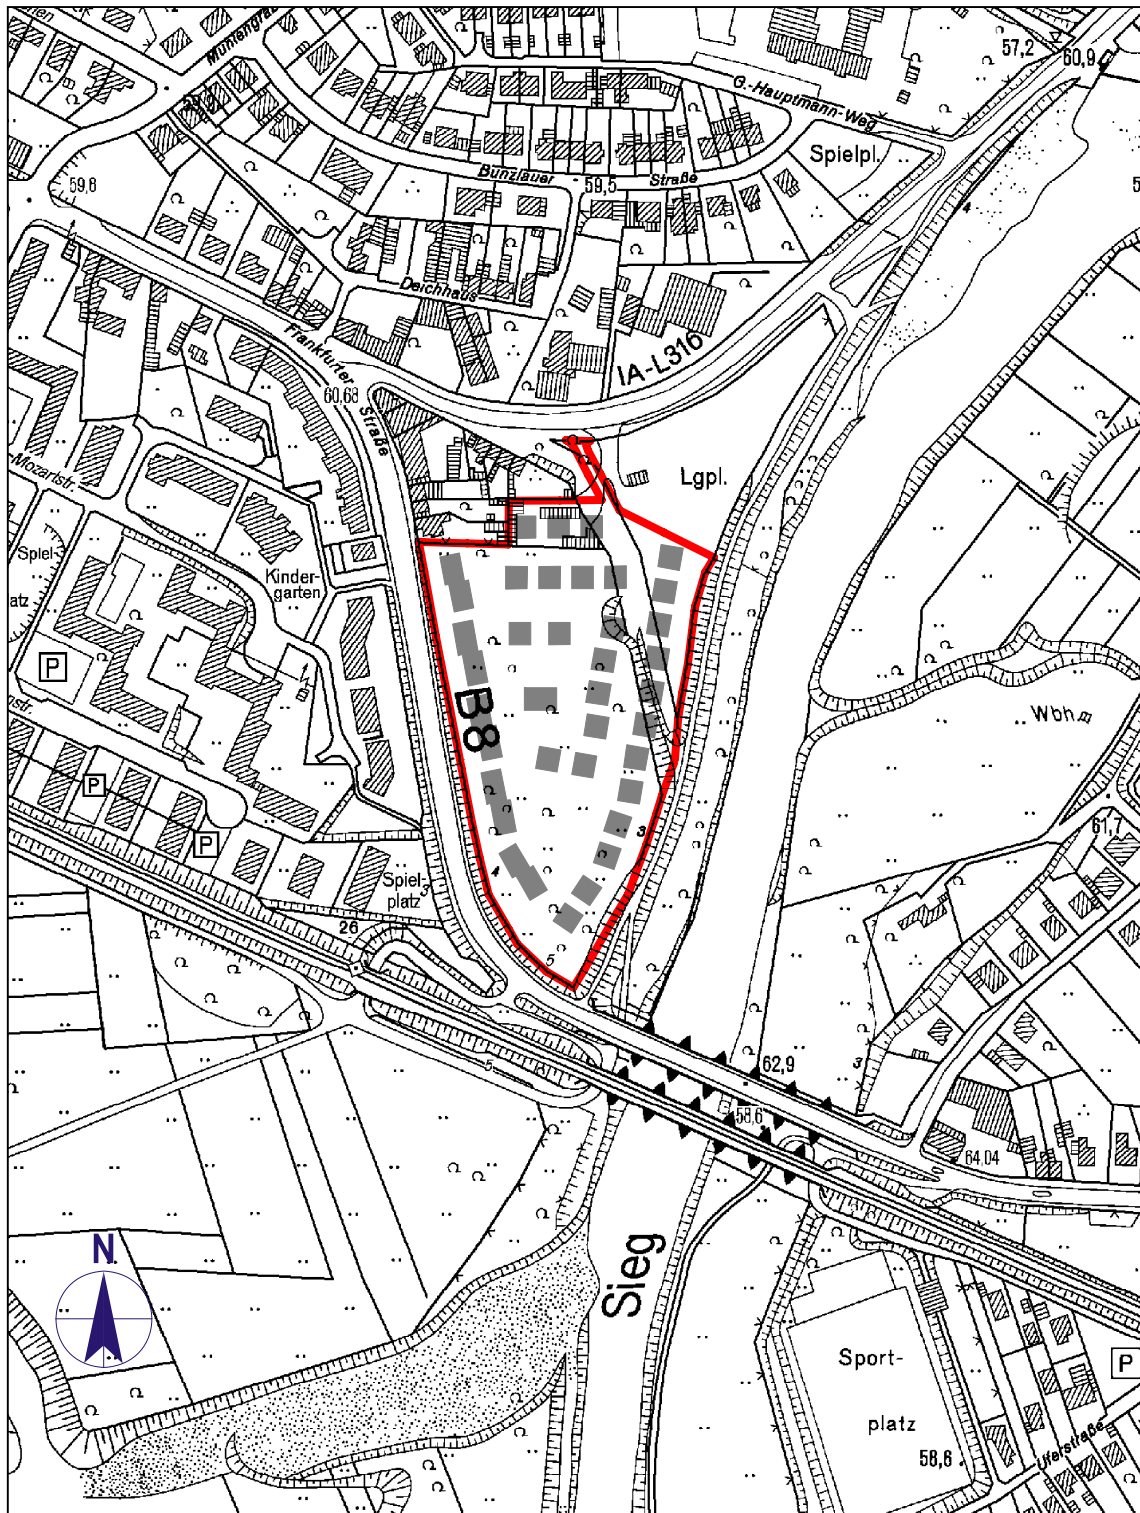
Übersichtsplan mit markiertem Bereich des Bauvorhabens Frankfurter Straße/Wahnbachtalstraße in Siegburg - Maßstab 1:4.000
